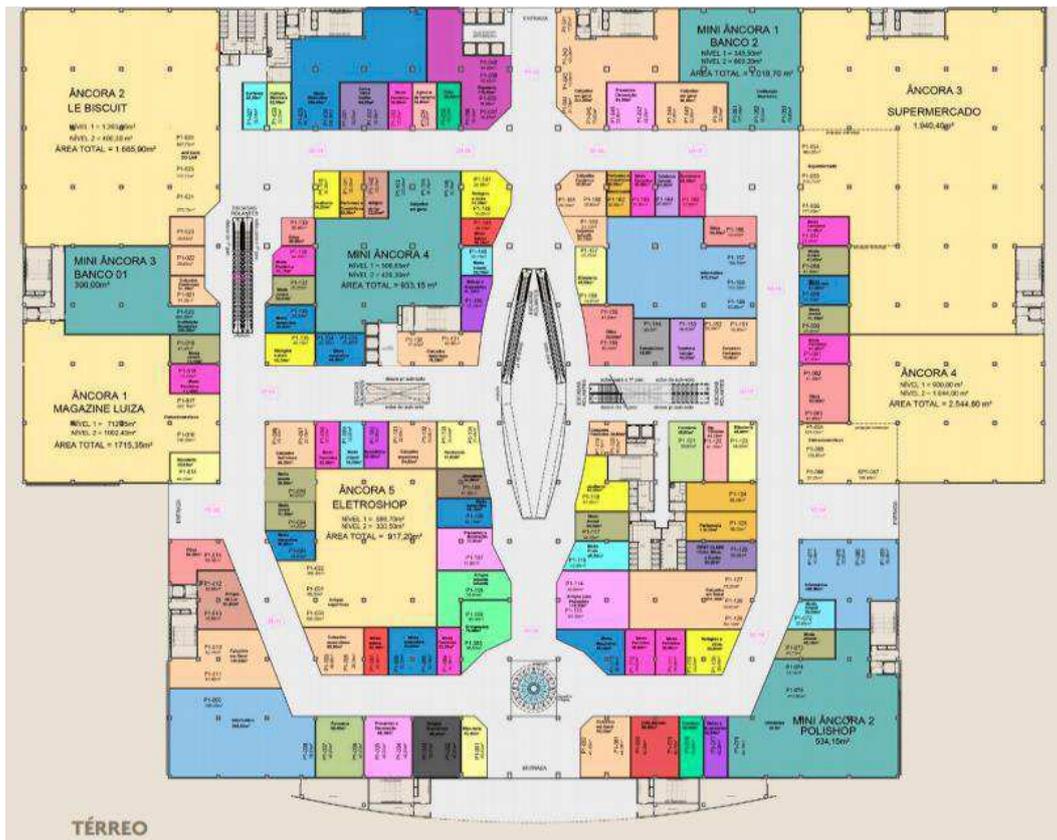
PLANTA BAIXA DO TÉRREO.
